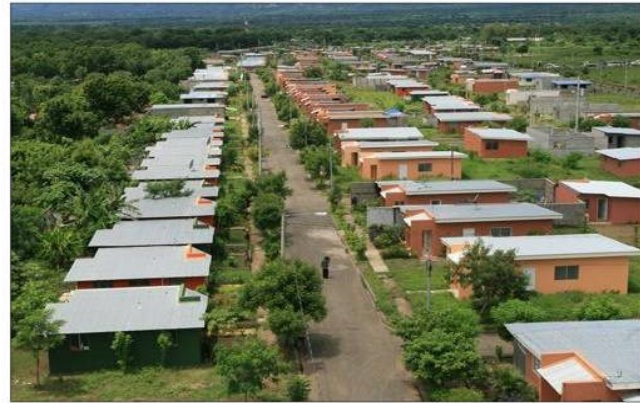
Vista del conjunto posición Sur de la urbanización Valle Santa Rosa.
